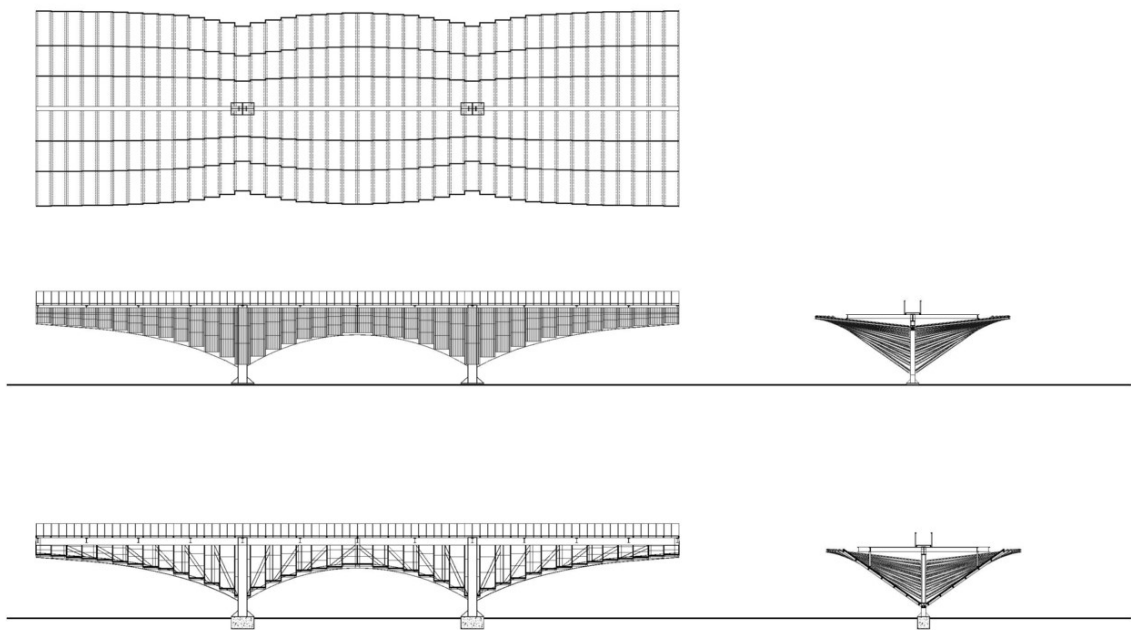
Схема фасадів парковки Power Wing Parking.
